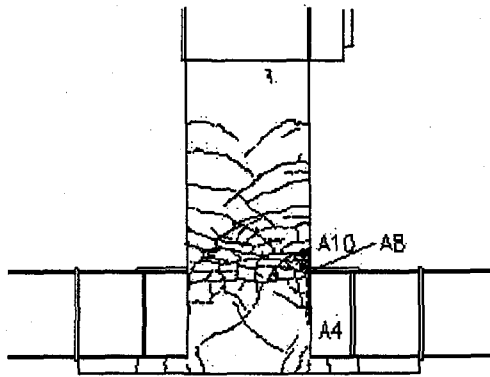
TYPE 2 最終時橋脚ひび割れ状況
